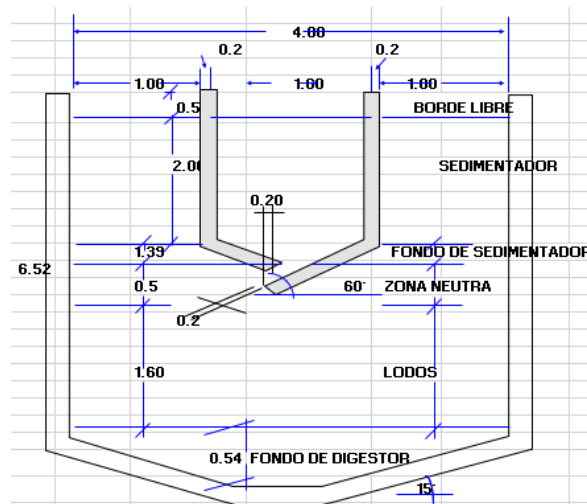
Medidas del Biodigester tipo tanque Imhoff vista en perfil y planta
